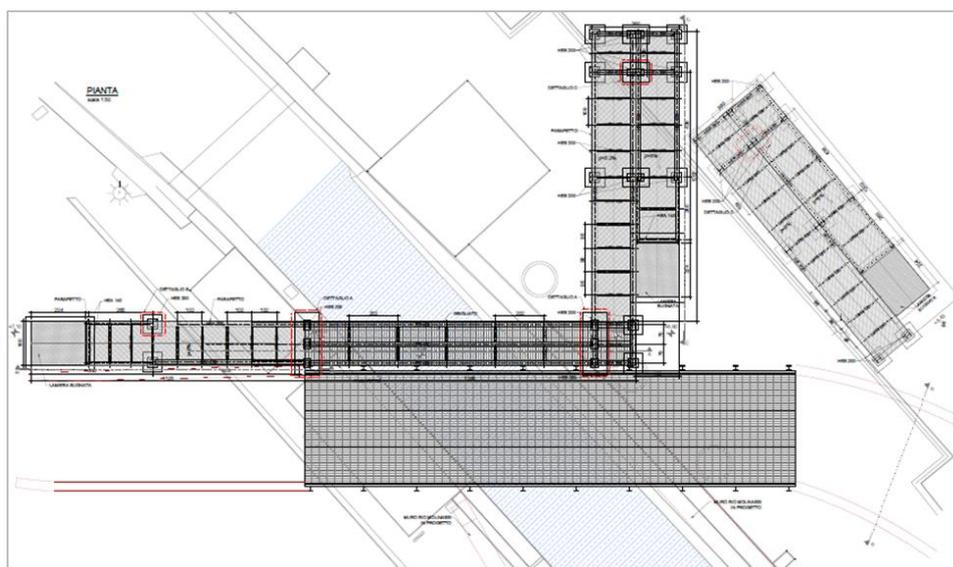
Pianta della passerella pedonale (e relative rampe di accesso) e del ponte temporaneo
